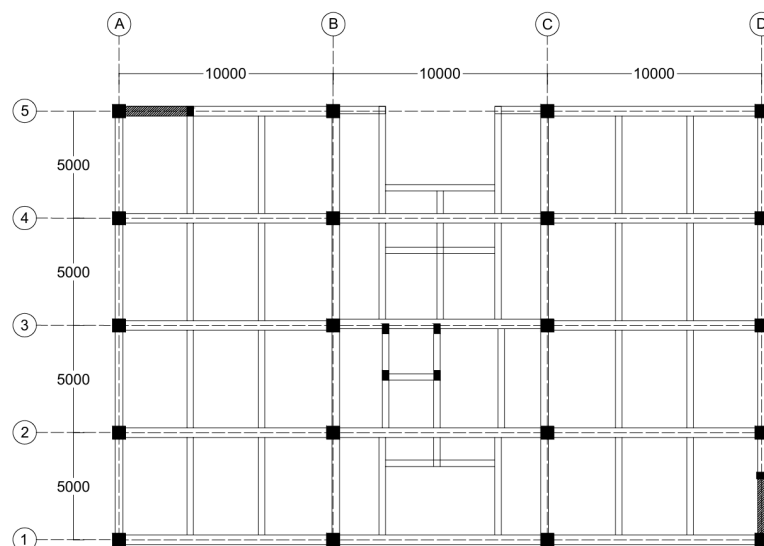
53 Denah Pelat A2 Model 3 Lantai 4
